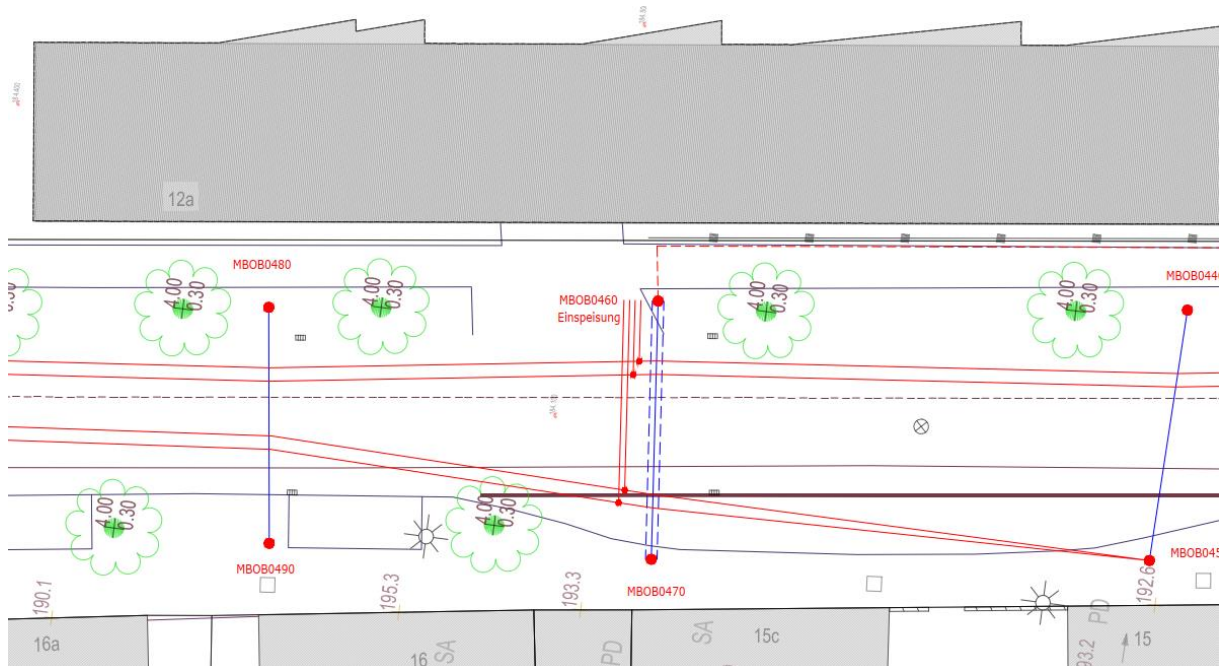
Standort der Einspeisung HBF1 am Mast MBOB0460, Quelle: Blatt 39 aus Unterlage (4.4)
